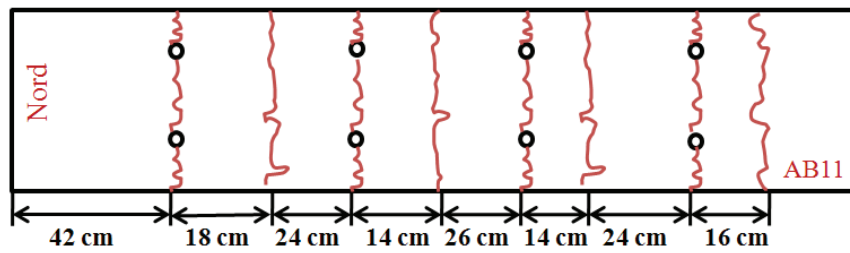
Relevé des fissures sur la poutre AB11
